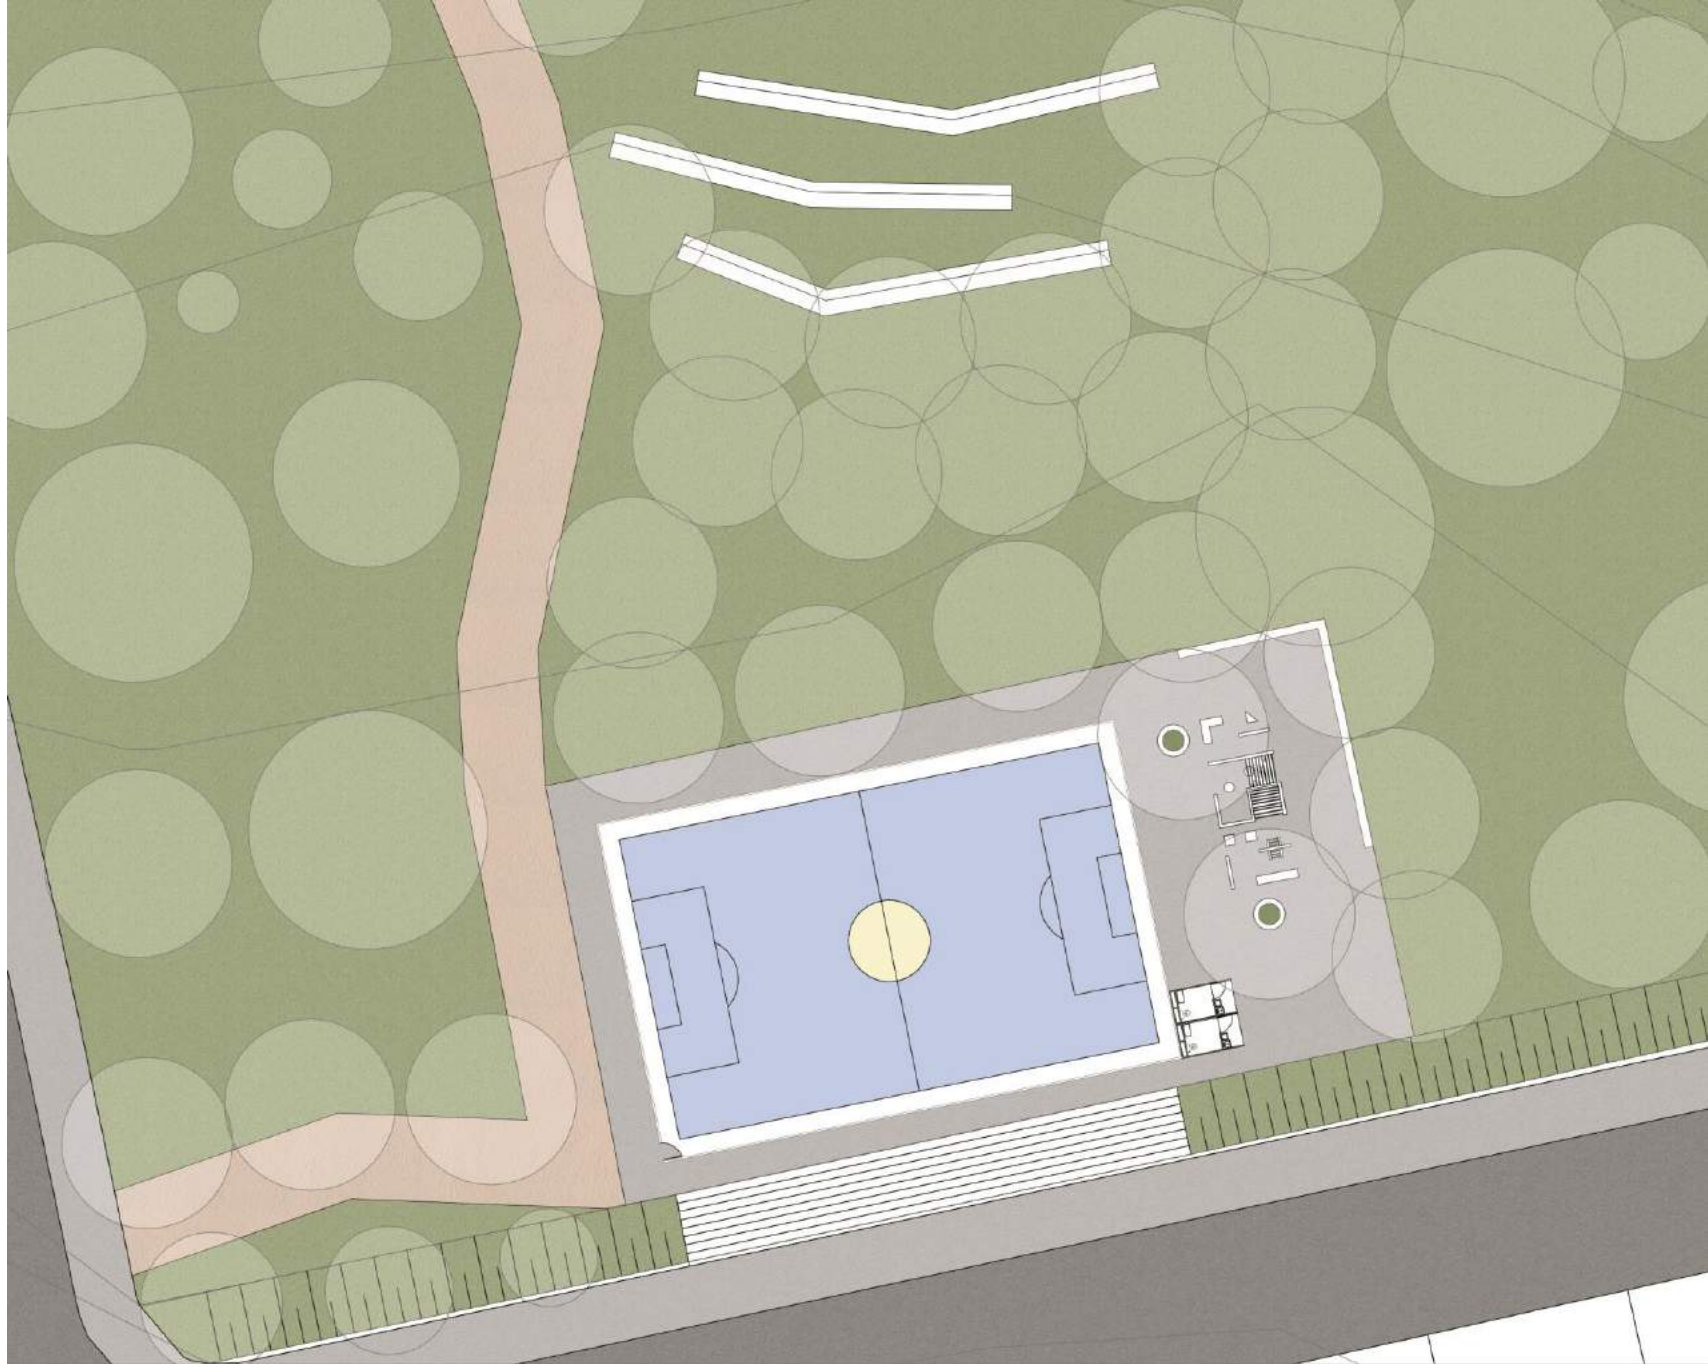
Planta área quadra, parquinho infantil e área de contemplação. Fonte: elaborado pela autora.
